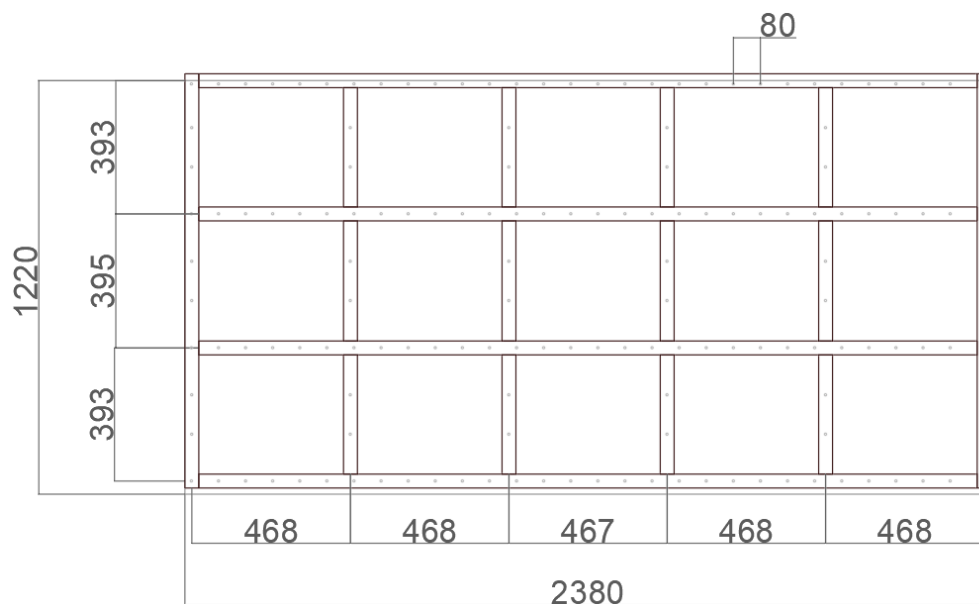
Vista en planta de módulo para ensayo, ancho original
